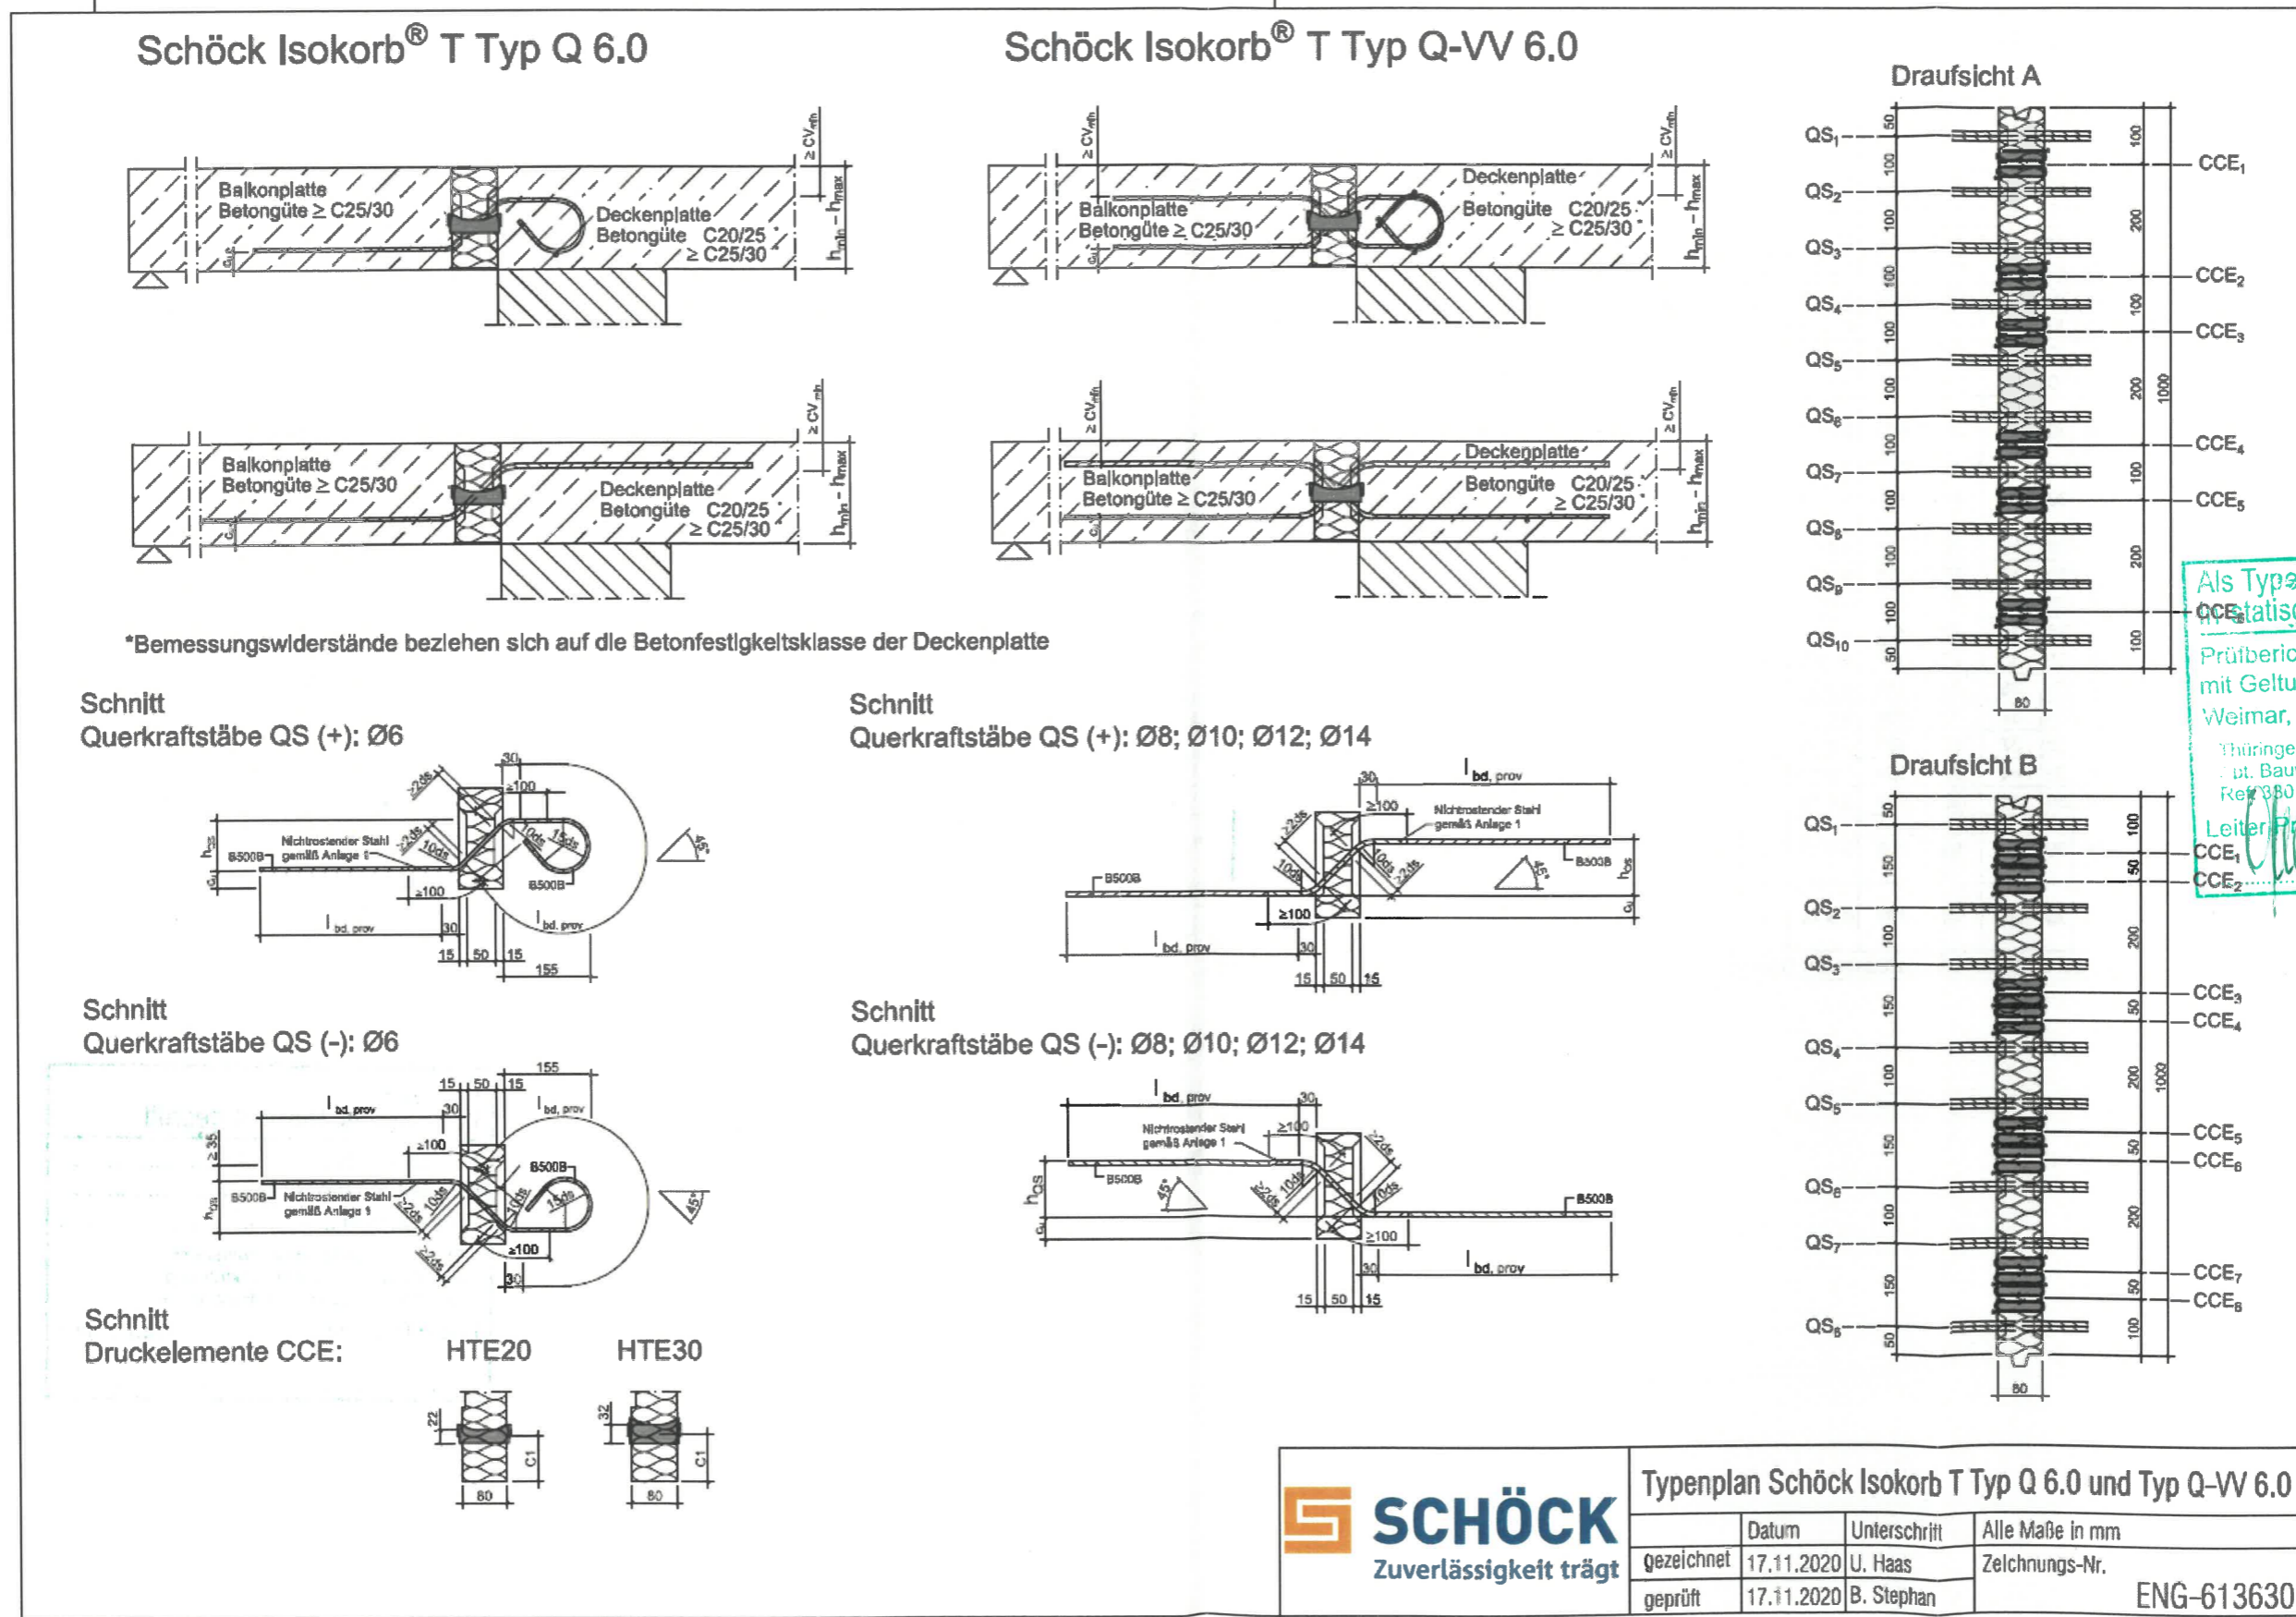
Typenplan Schöck Isokorb® T Typ Q 6.0 und Typ Q-VV 6.0
